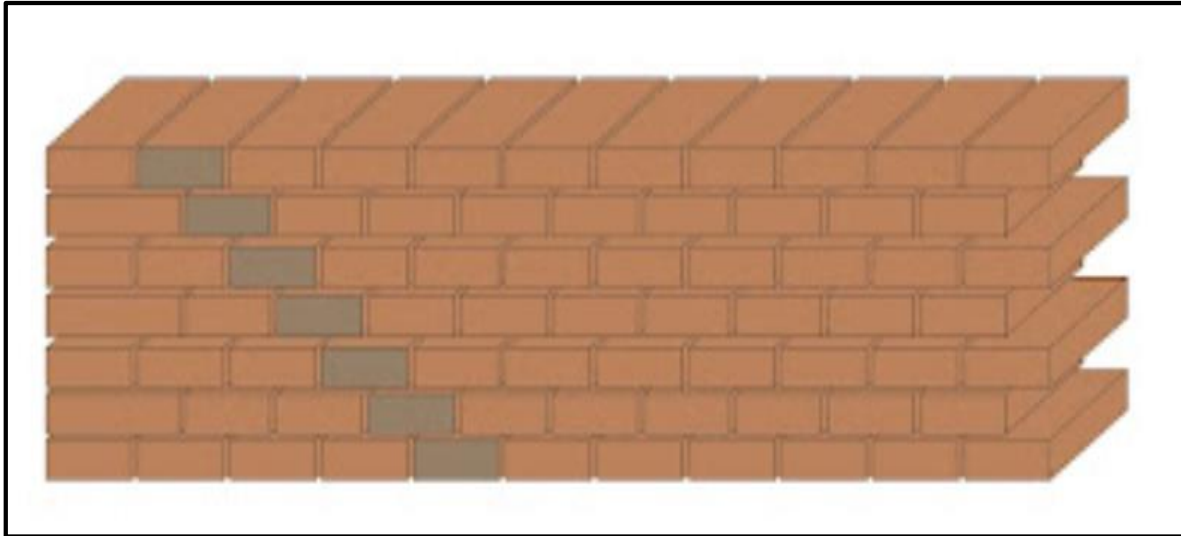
Muro de albañilería asentado con ladrillos de cabeza. Tomada de “Teoría básica sobre Albañilería”, por Donaire, 2011.
